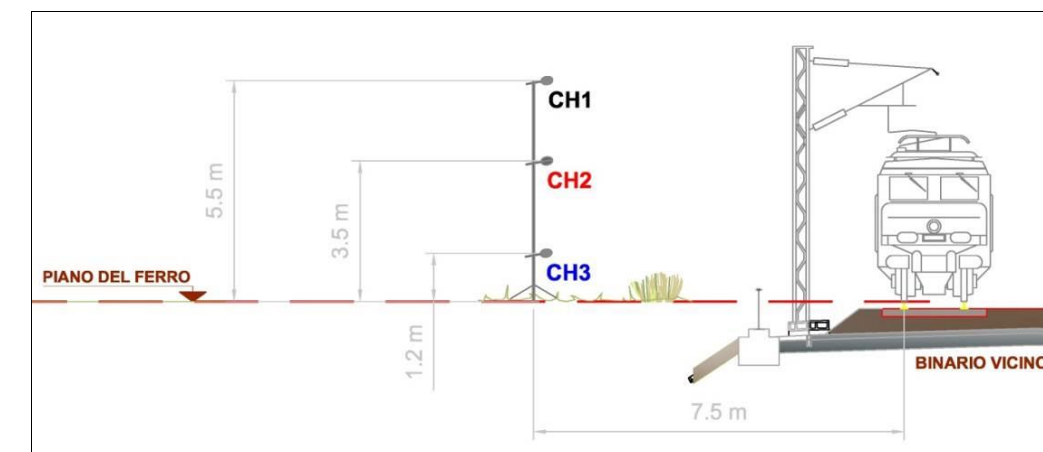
Localizzazione in sezione della postazione di misura ferroviaria
